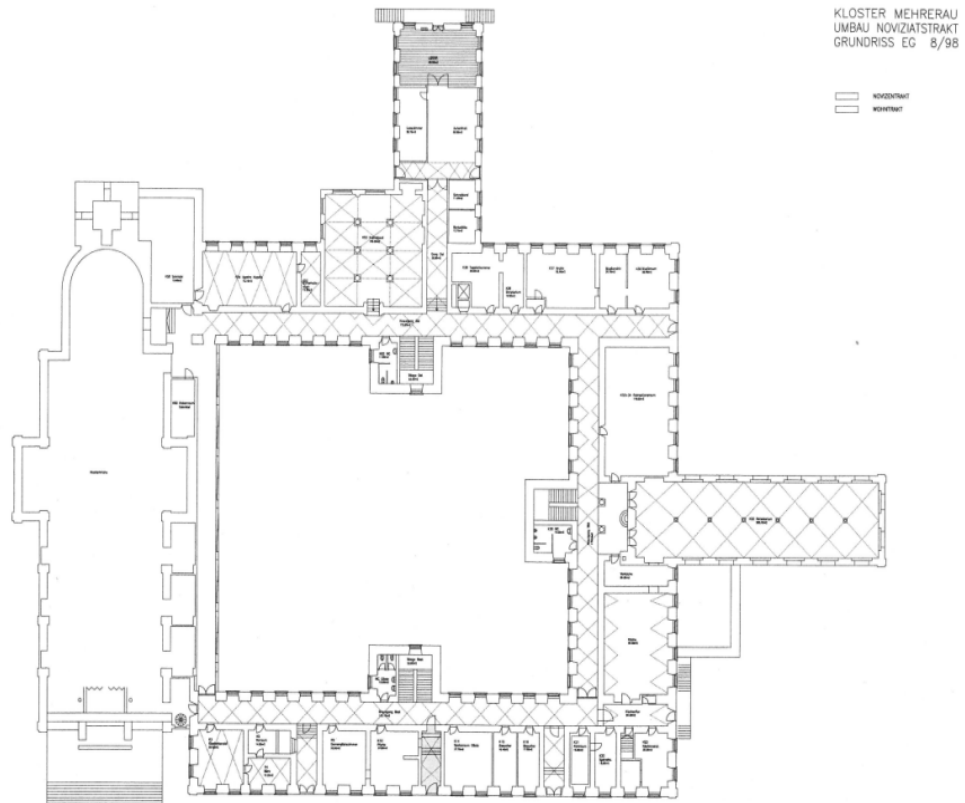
Stift Wettingen-Mehrerau, Grundriss, Pater Laurentius Wocher
